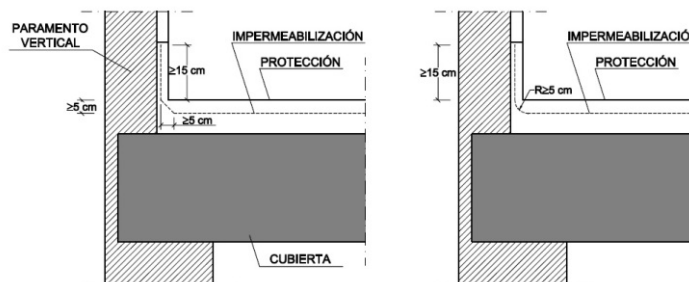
Encuentro de la cubierta con un paramento vertical
